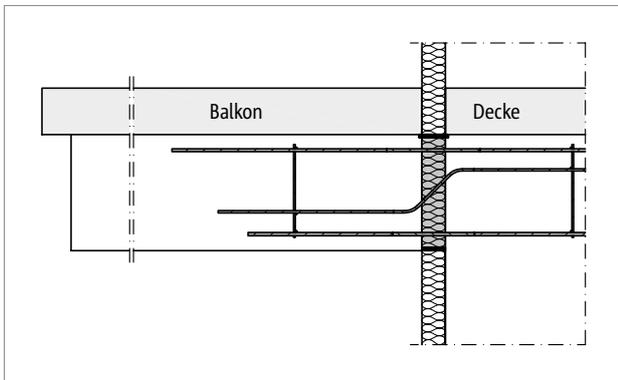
Schöck Isokorb® T Typ B: Balkonkonstruktion mit frei ausragenden Unterzügen (Fertigteilbalkon)
